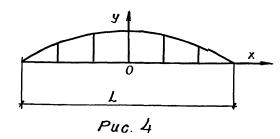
принят по руководству то использованию системы "САПФИР-90 Адля автоматизированного проектирования стропильных железобетонных конструкций.
